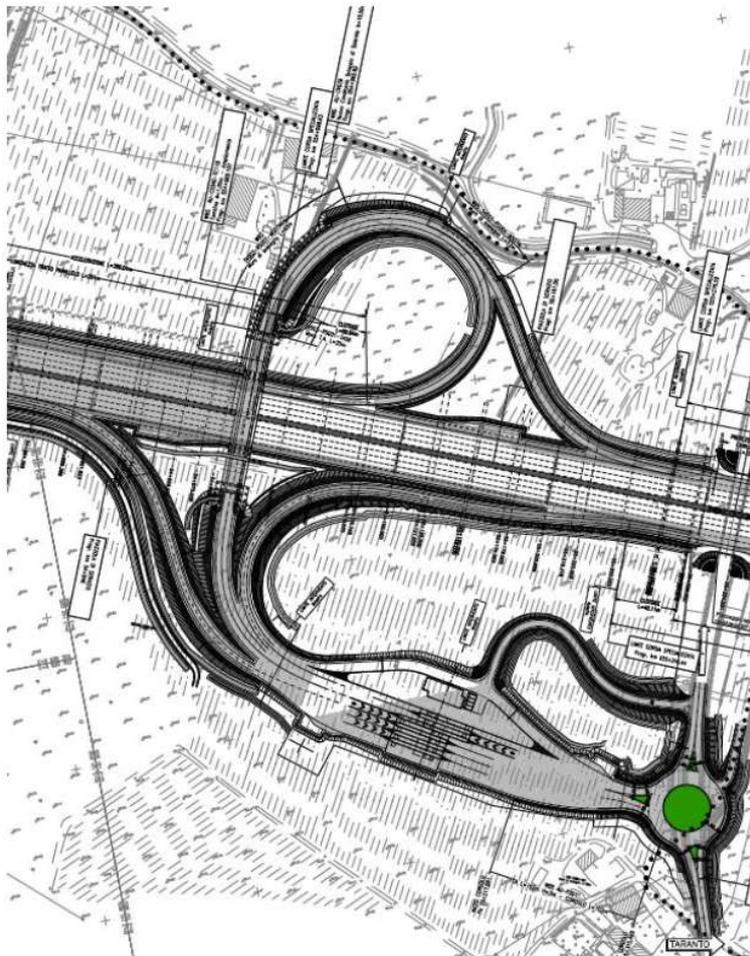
Stralcio planimetrico del nuovo svincolo di Solarolo
